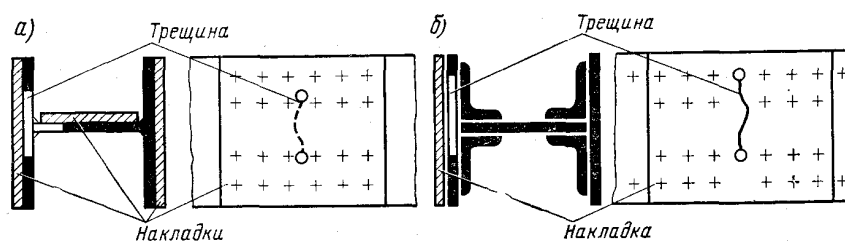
Перекрытие трещин накладками на высокопрочных болтах: а – в сварных элементах; б – в клепаных
